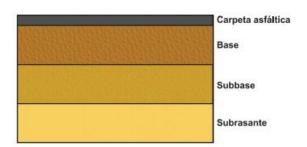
Estructura de un pavimento flexible tradicional.
